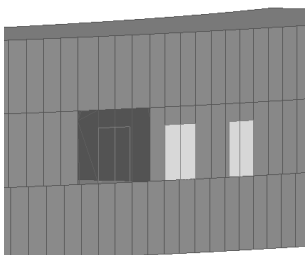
No aparecen los pilares ni el volumen en Design Builder.
